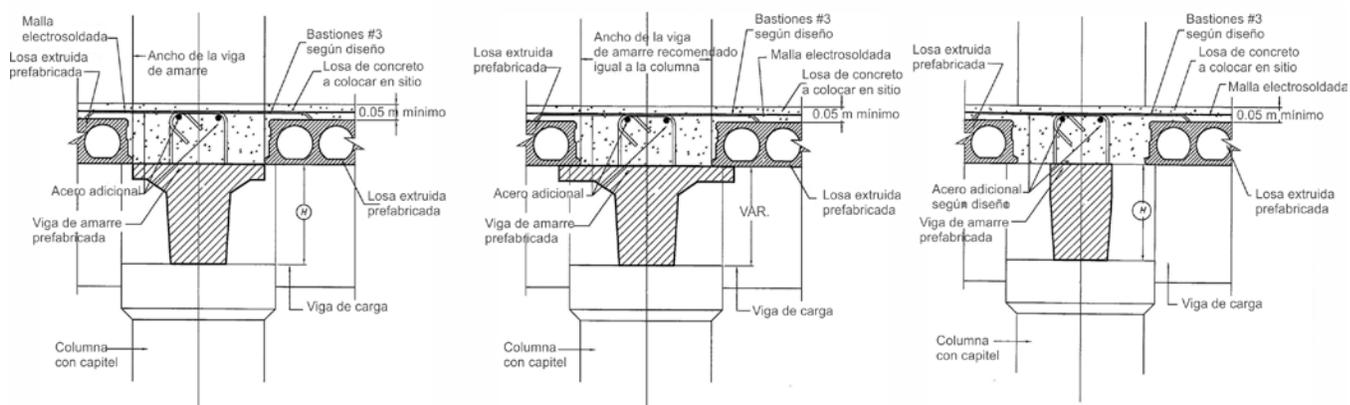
Secciones C-C, opciones 1, 2 y 3 de conexión viga de amarre central - entrepiso
